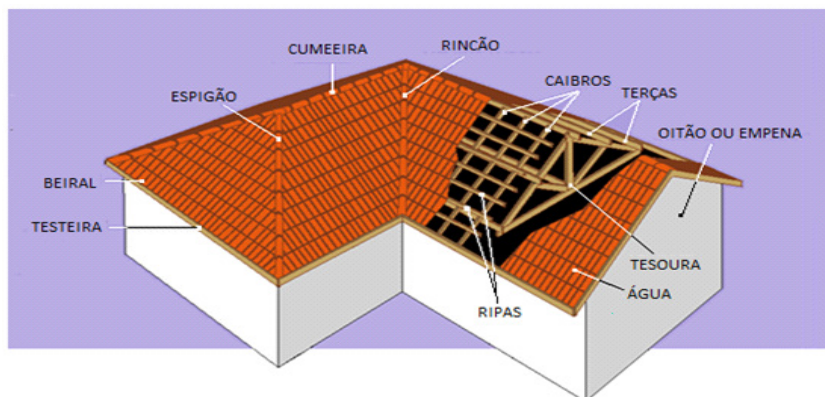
Principais componentes de um telhado em madeira e telhas cerâmicas
